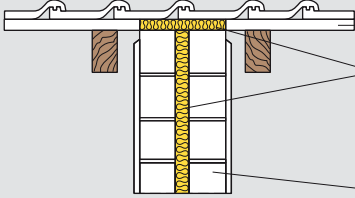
Brandwände im Dachbereich – Industriebau; Auszug aus: Bayerische Versicherungskammer München, Brandwände und Öffnungen in Brandwänden, Anforderungen und Ausführung [19]
